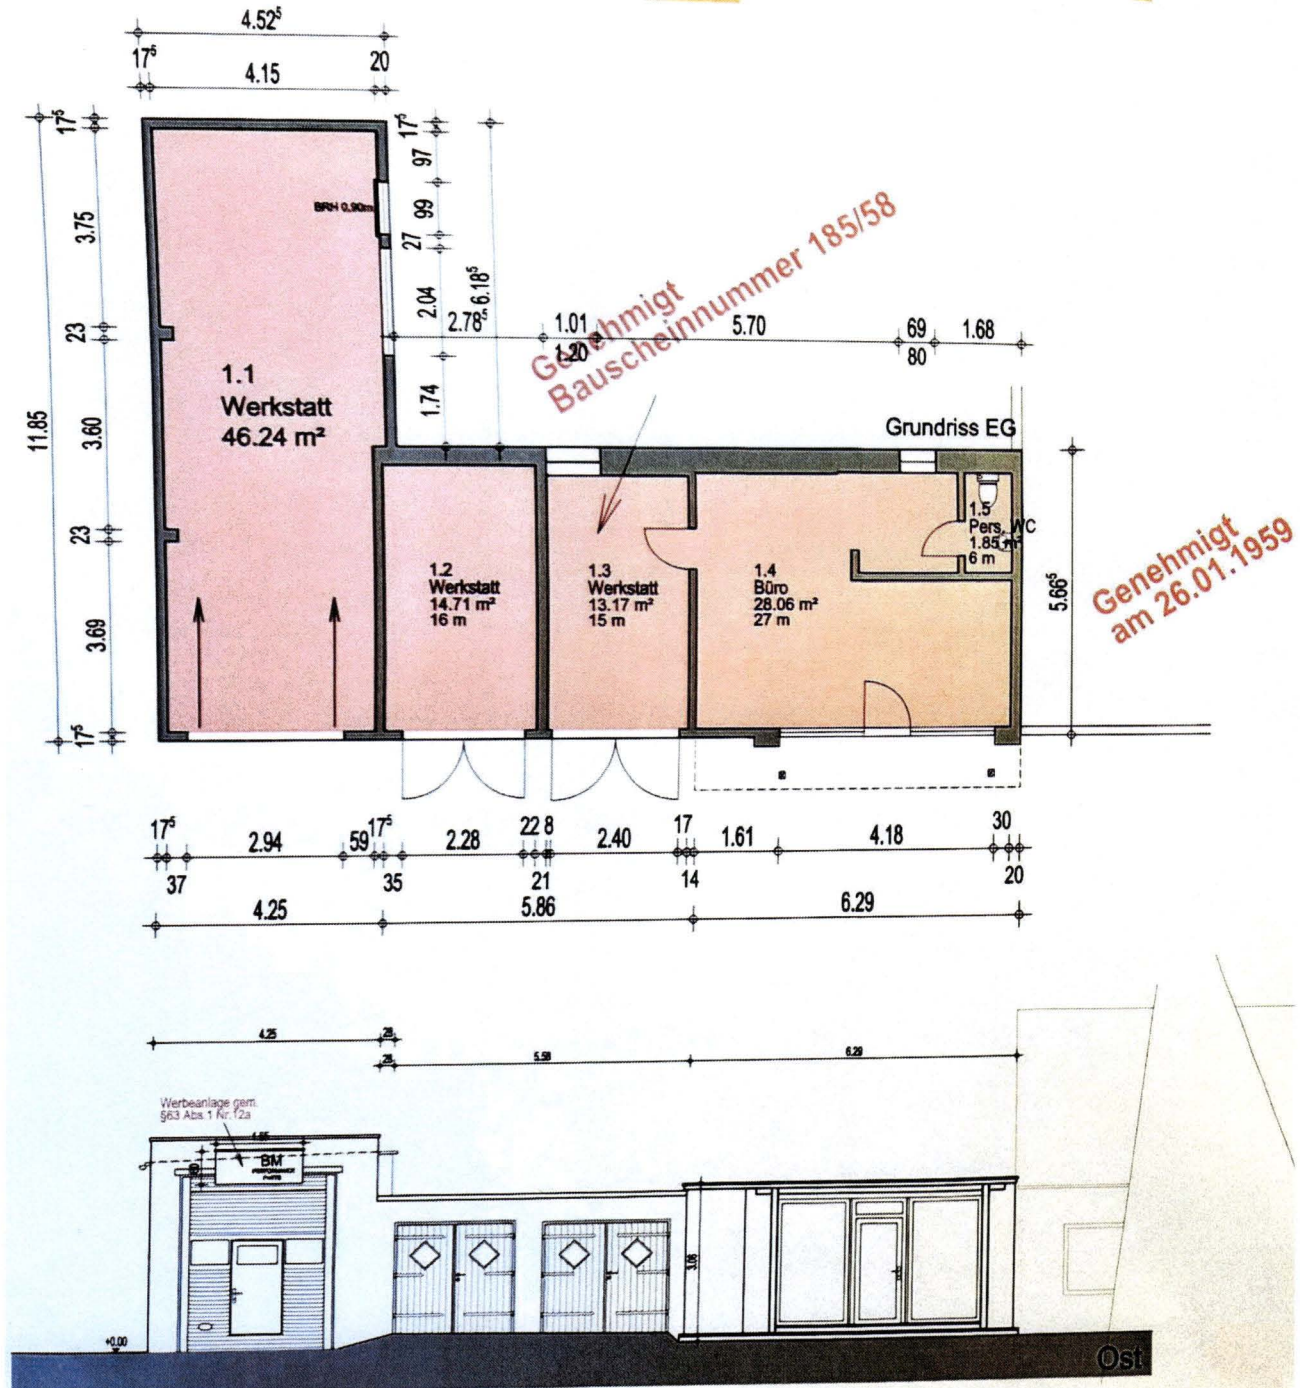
Grundriss Büro, Halle 1 und Garage 1 (EG, straßenseitig)
